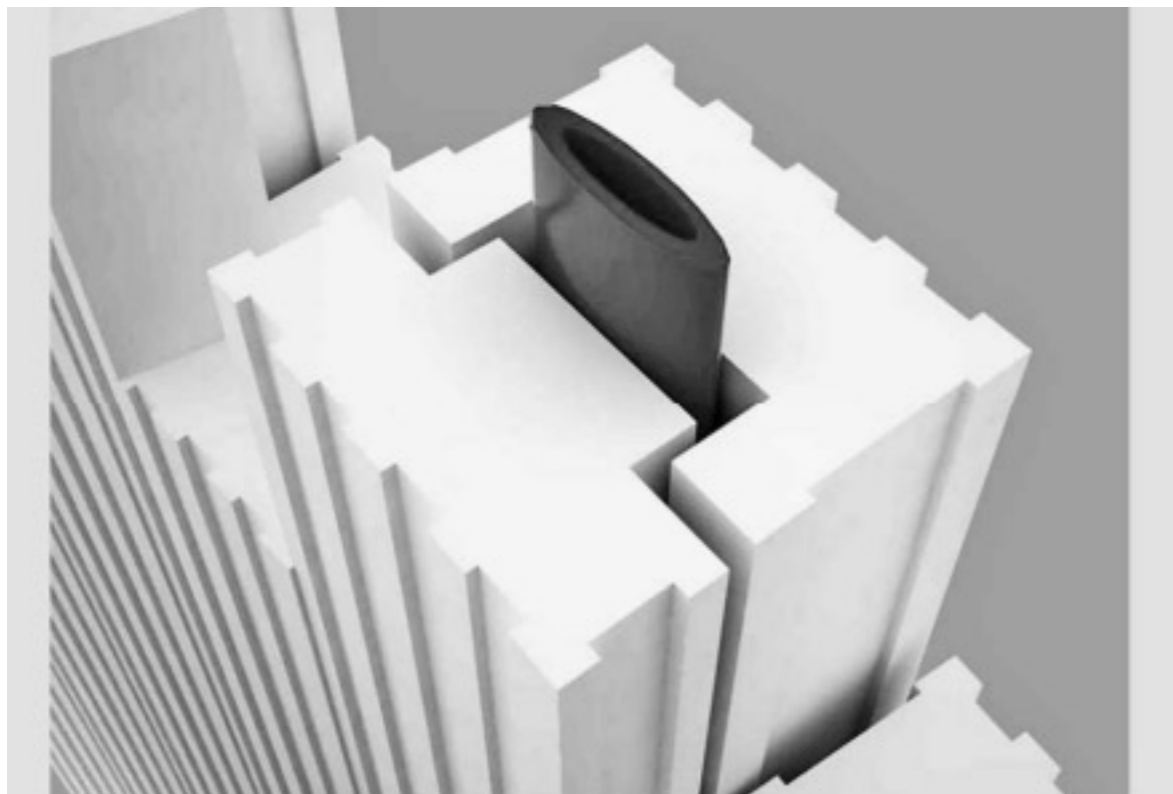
Ricostruzione tridimensionale del bocchetto di forzamento preventivo
